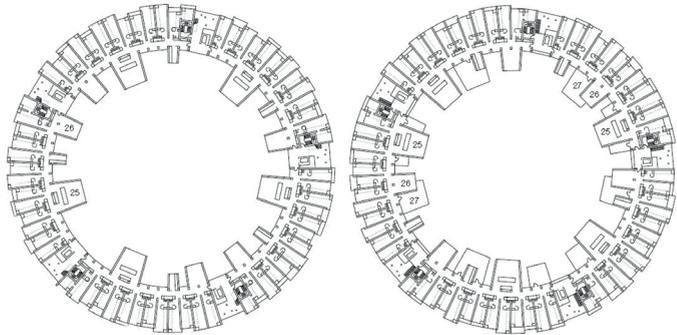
Grundriss, Tietgen Studentenwohnheim
